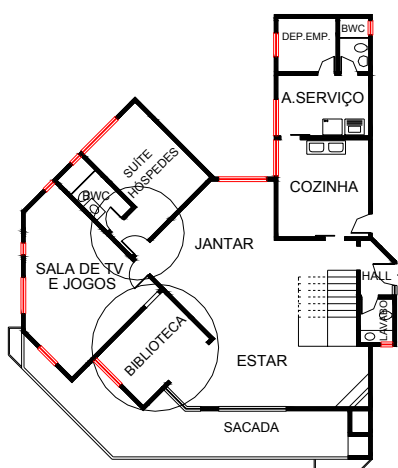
Planta Baixa do apartamento 801 - Estudo de caso C (Apartamento Triplex).
